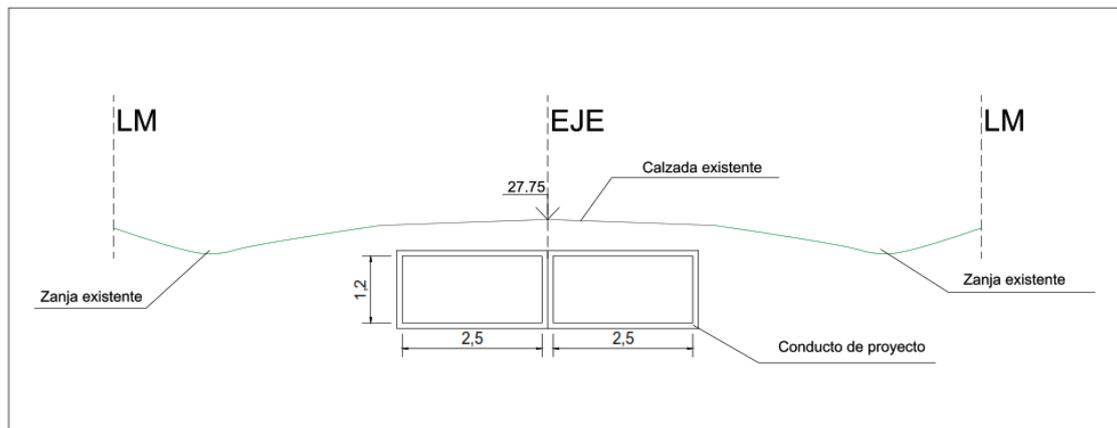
Perfil Transversal en calle French. Fuente: Elaboración propia
